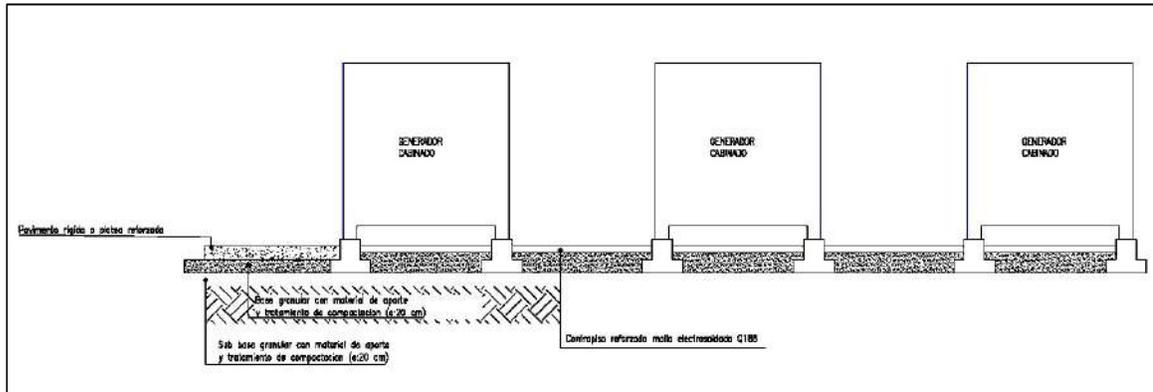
Plano de implantación de los generadores en corte longitudinal.
